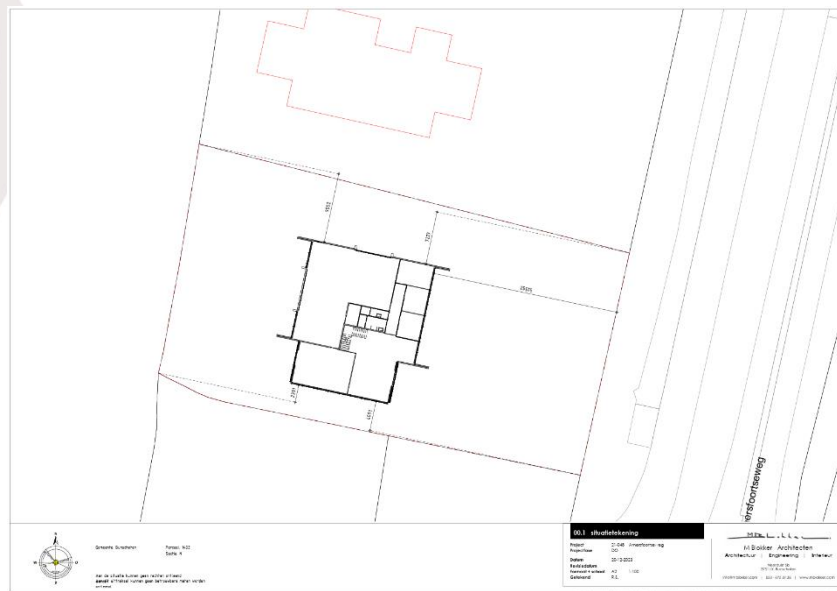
, Situatietekening van nieuwbouw (bron: M Blokker Architecten)
